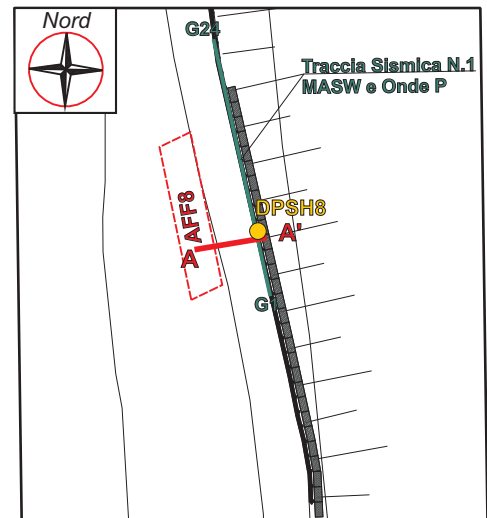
Planimetria del tracciato stradale in corrispondenza del tratto terminale prima dell'attraversamento della strada sul Fosso della Fonte, in scala 1: 1.000
